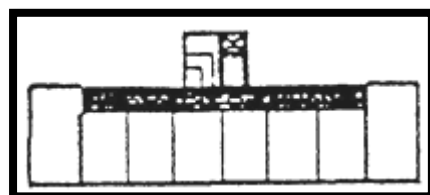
Bentuk Denah *Centre Corridor Plan
